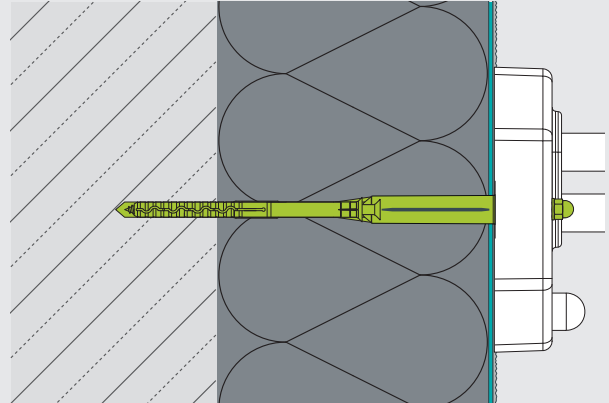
Wärmebrückenreduzierte Montage im Dämmstoff und Verankerung zum Untergrund – das Montageelement wird nach Fertigstellung des WDVS im Untergrund befestigt. Das Anbauteil wird anschließend im Montageelement verschraubt.
